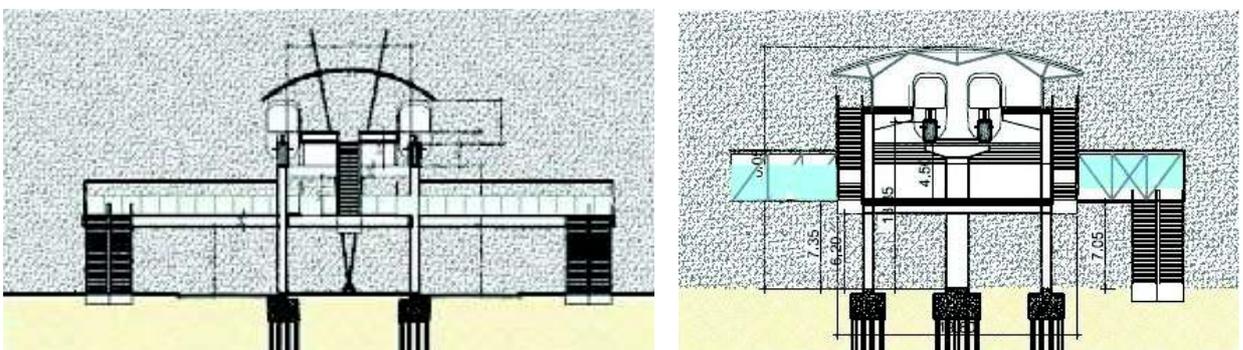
Desenho da Estação Padrão – Cortes Transversais.
